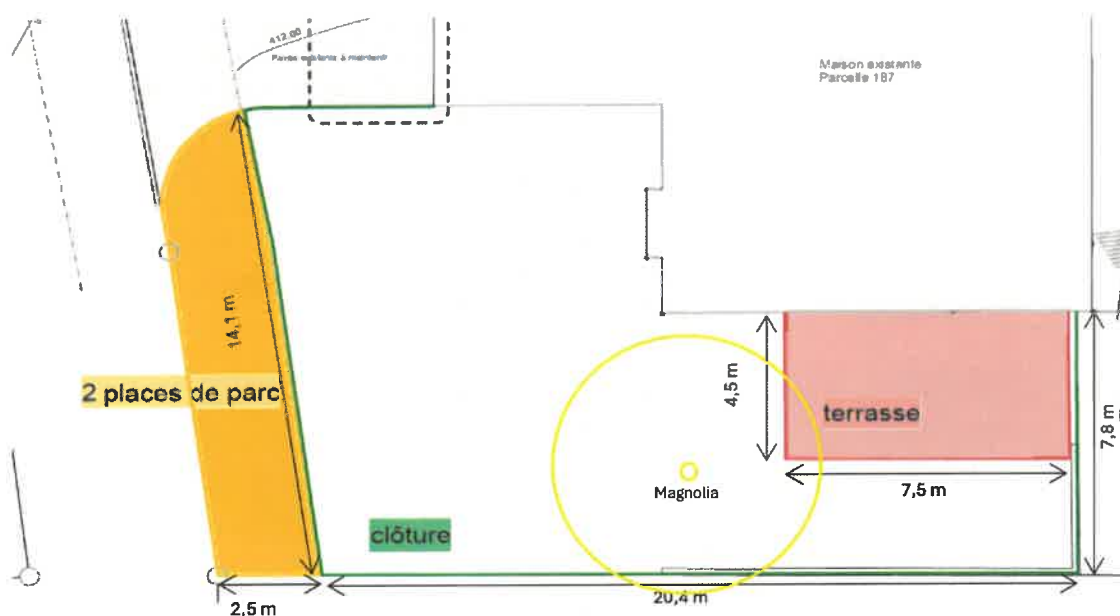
Représentation schématique des places de parc, de la clôture et de la terrasse (plan à l'échelle)
